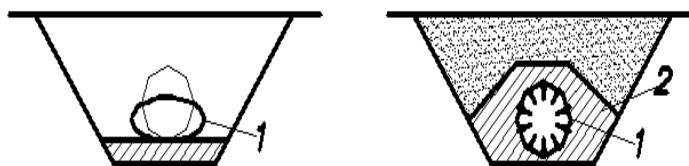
Схема бетонирования: 1-воздухонепроницаемая камера; 2-бетон
